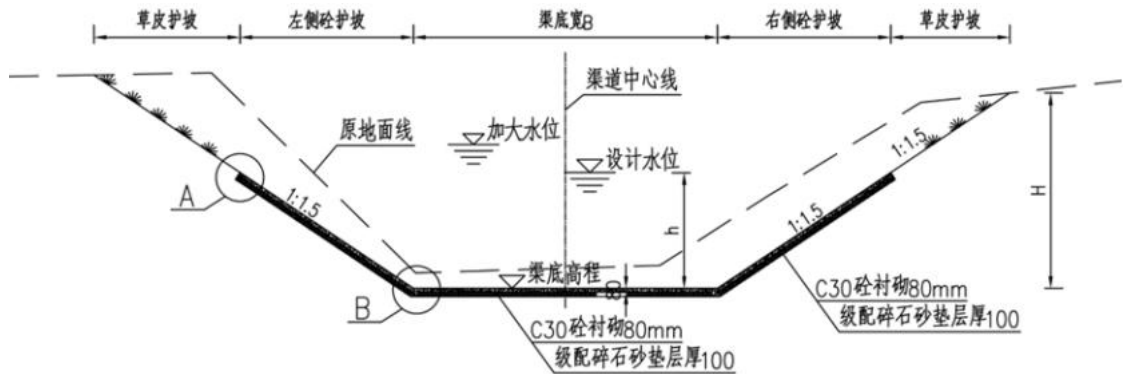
挖方渠段混凝土衬砌梯形渠道典型断面图
